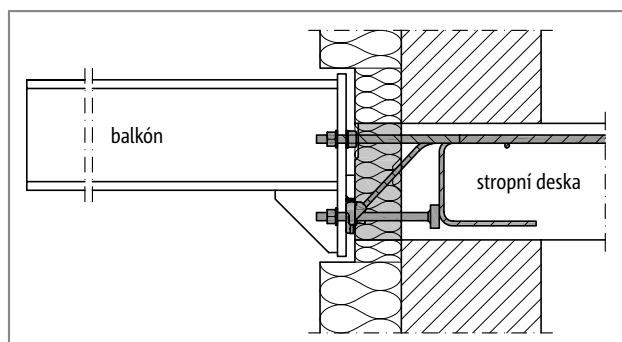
Schöck Isokorb® T typ SKP: Volně vyložený balkón
